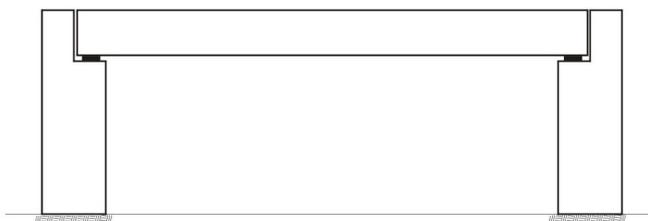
Ponte em viga simplesmente apoiada com um único vão
